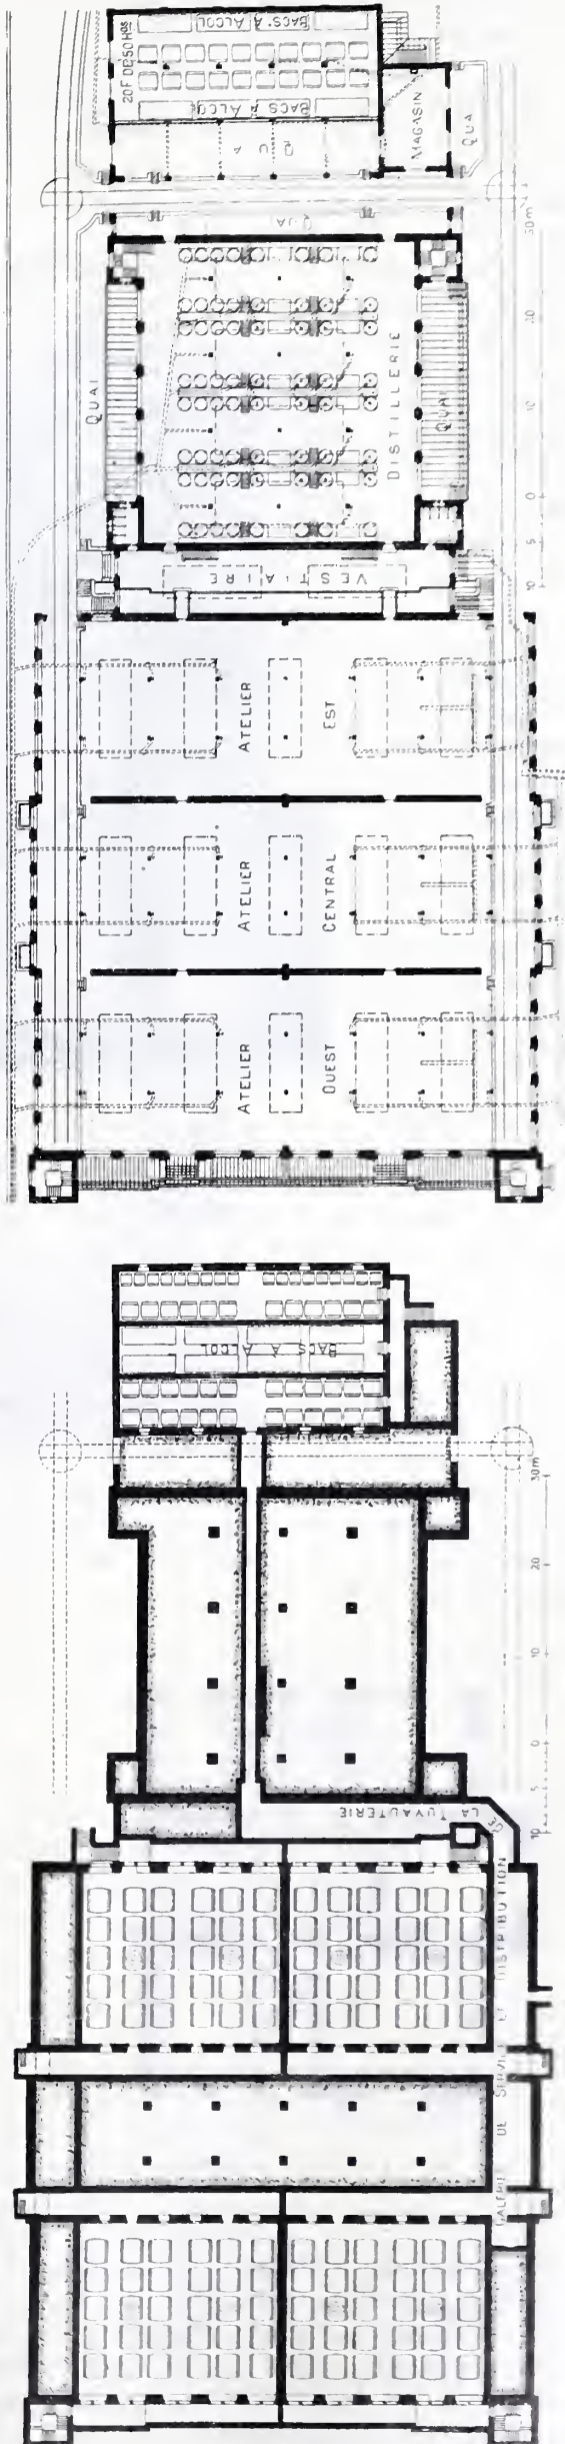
Plan du sous-sol. — Echelle 1 : 1000.
